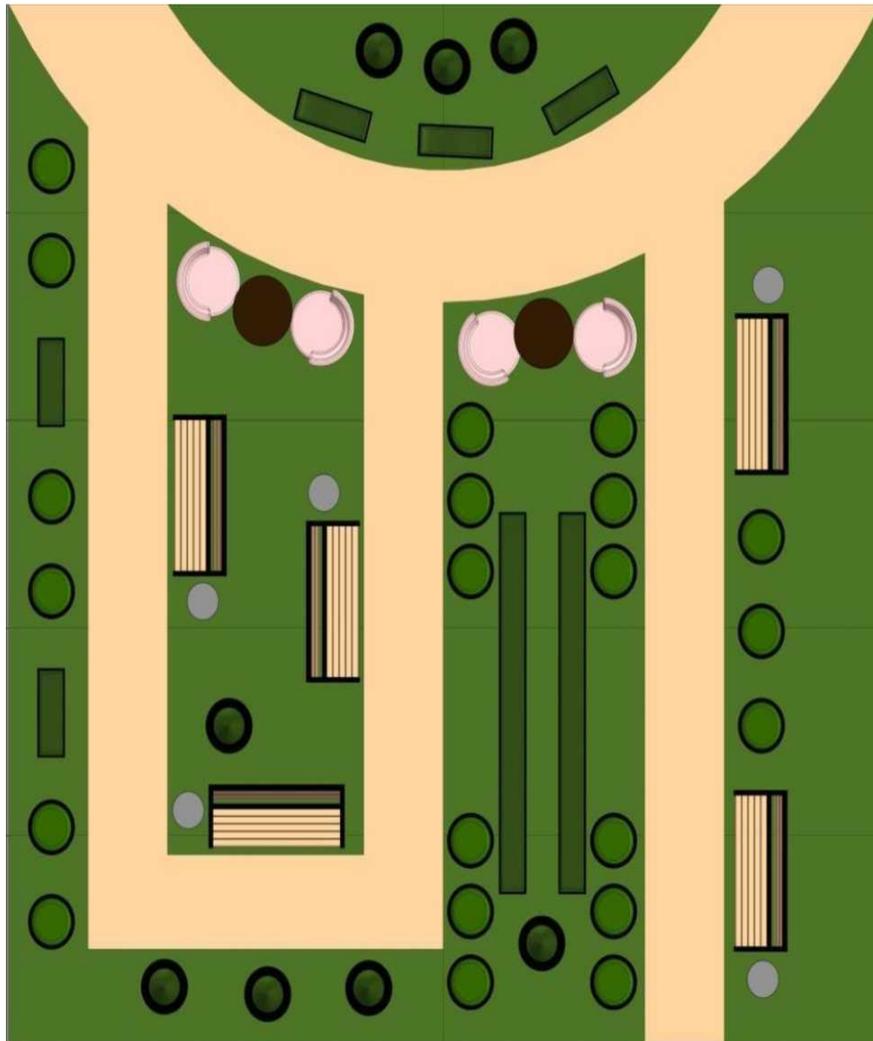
Схема планування зони відпочинку з літнім садом
